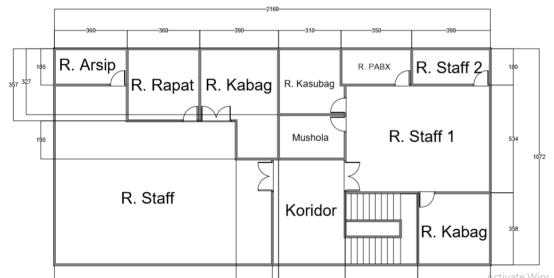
Perencanaan Denah Gedung D Lantai 1
